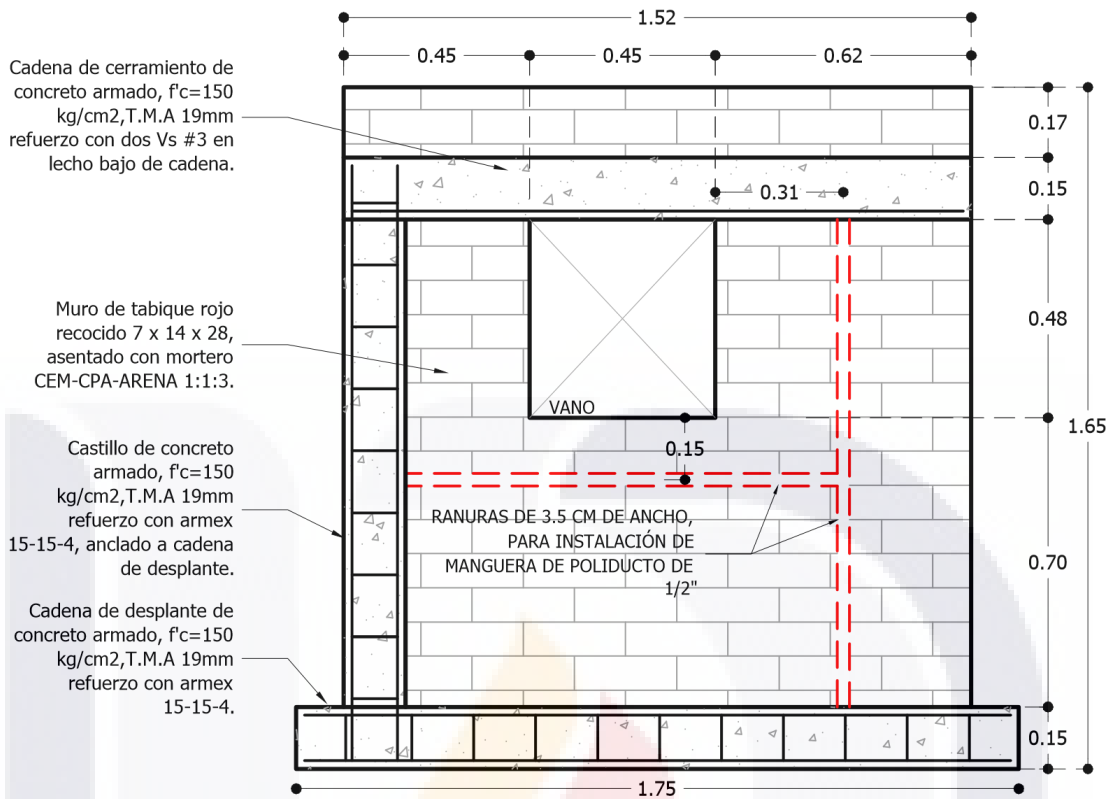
Detalle constructivo de diseño de MTR 1 Cara B
